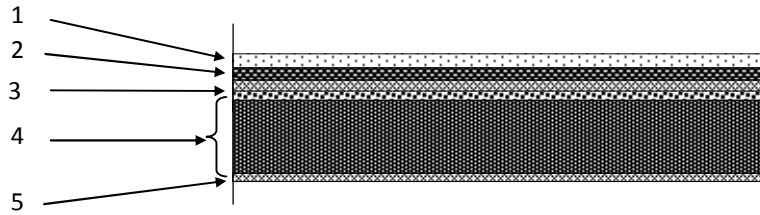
Coupe verticale d'un plancher d'étage courant.
